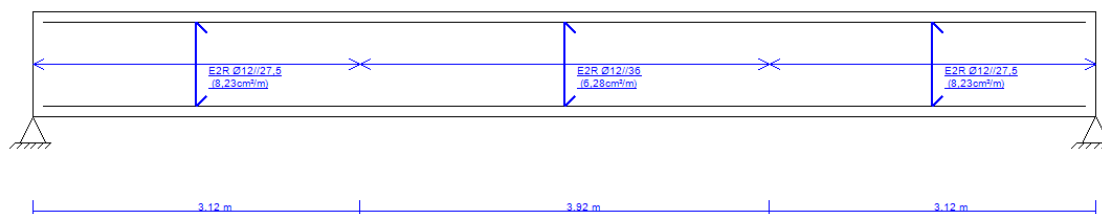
Pormenorização da armadura transversal solução (ii)
